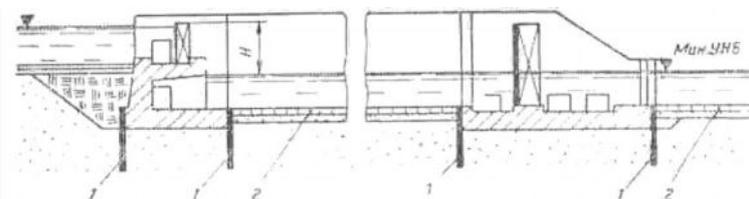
Продольный разрез шлюза с водопроницаемым днищем.
